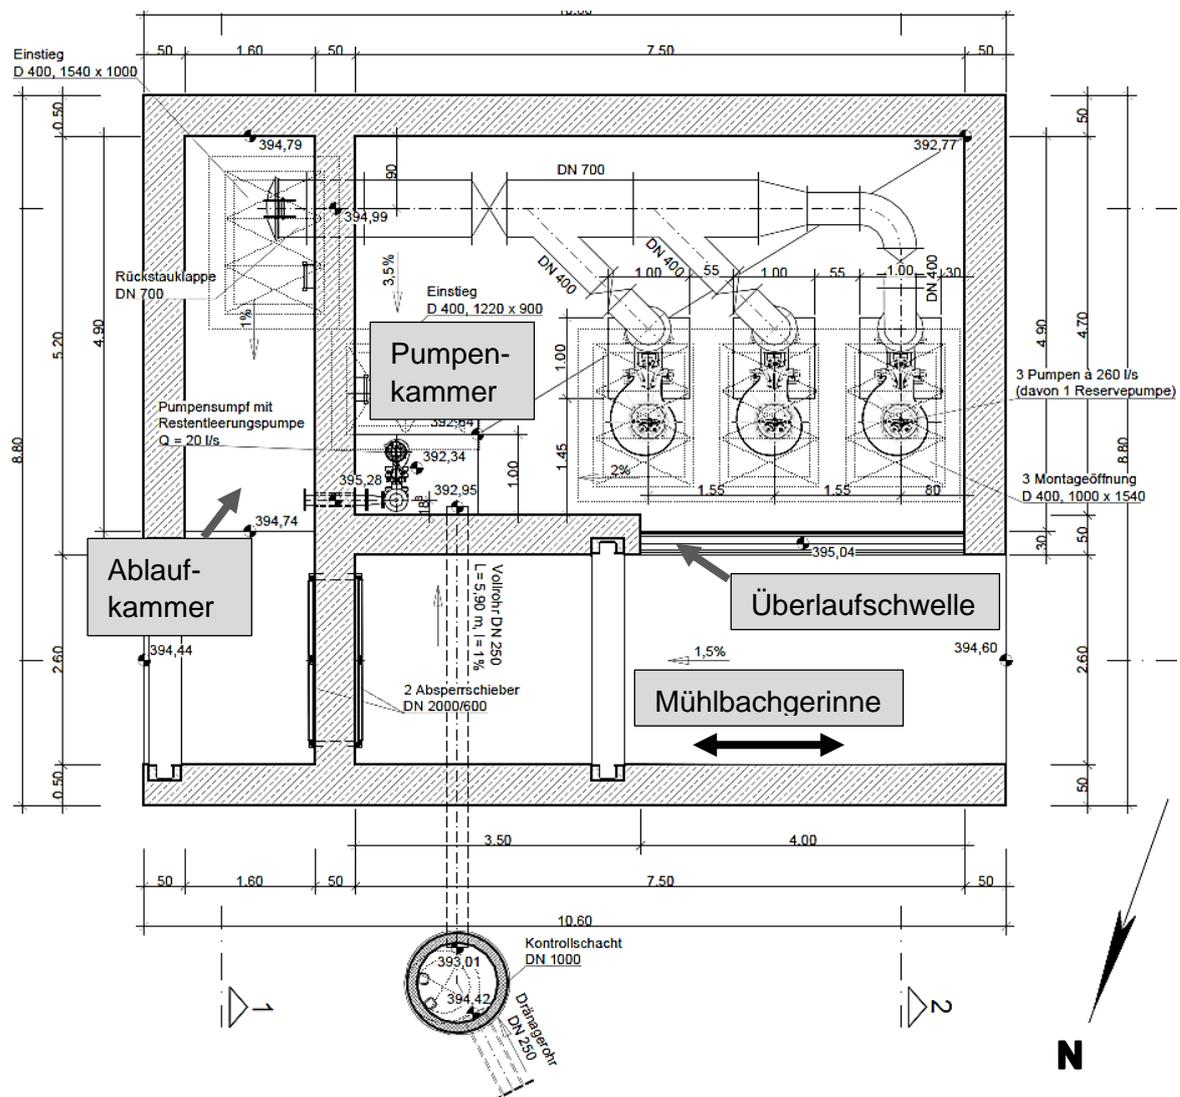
Grundriss Schöpfwerks (Auszug aus Plan E 63)
